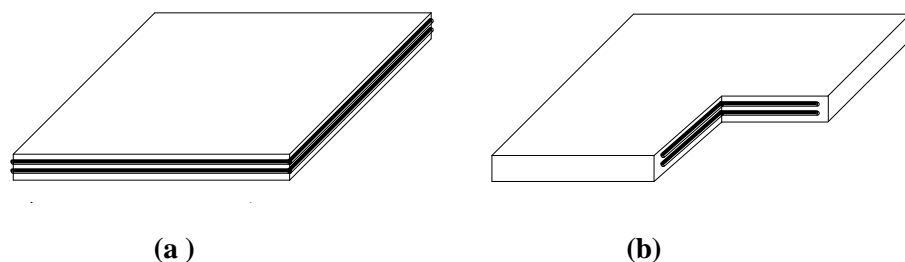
(a) Apoyo semirecubierto y (b) Apoyo recubierto
